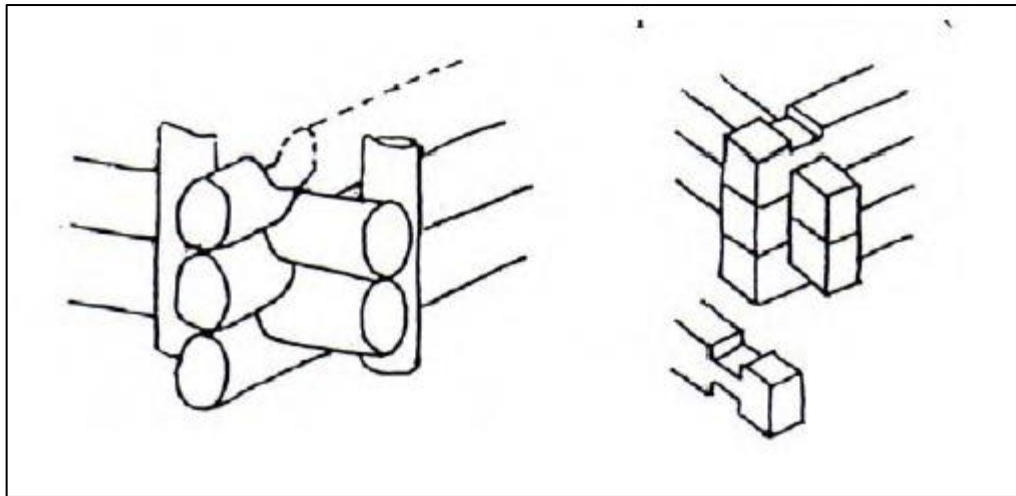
Construção em troncos de madeira. [LEONARDO DA VINCI, 2008];
